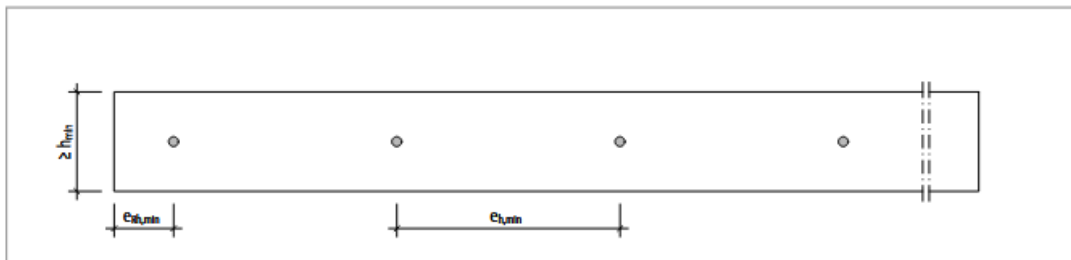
Schöck Stacon® Typ LD: Minimale Bauteilabmessungen und Dornabstände bei einer Platte
